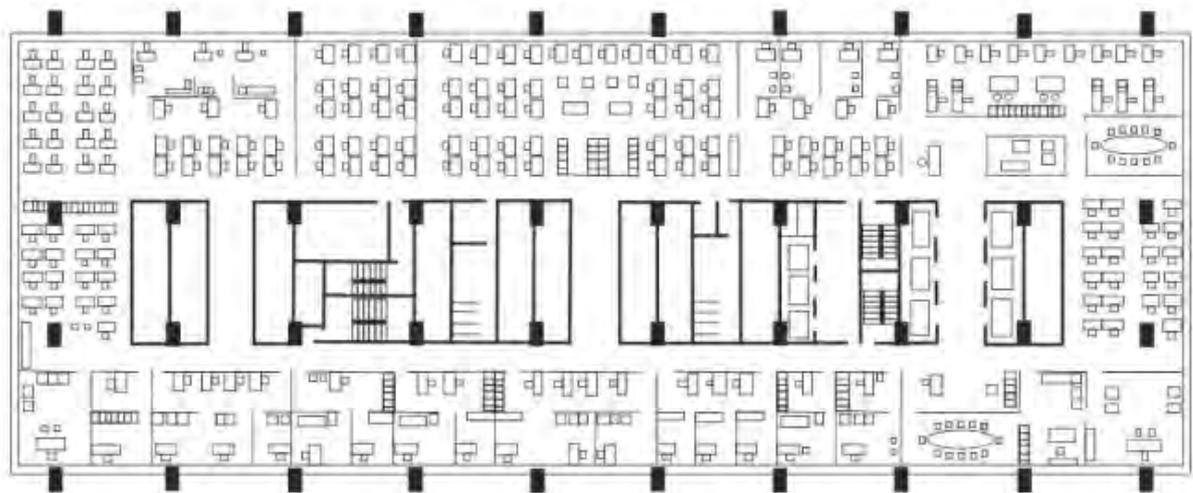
Skidmore Owings and Merrill, Planta Tipo, Chase-Manhattan Bank. Nova York, 1961.
